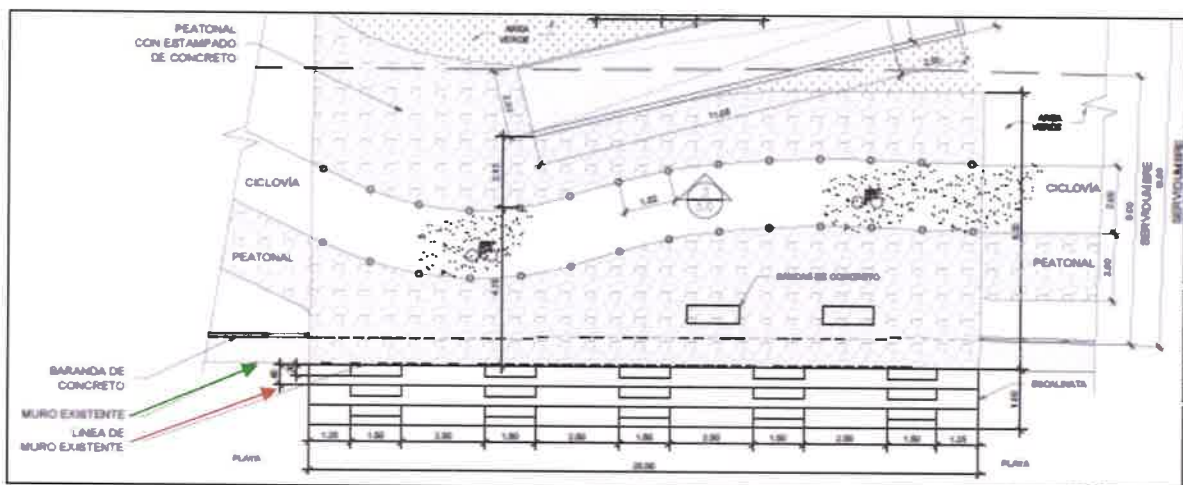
Plano de anteproyecto de plazoleta, se pueden observar, el muro existente (flecha verde) y la línea de muro existente (flecha roja) y hacia la playa las escalinatas.
